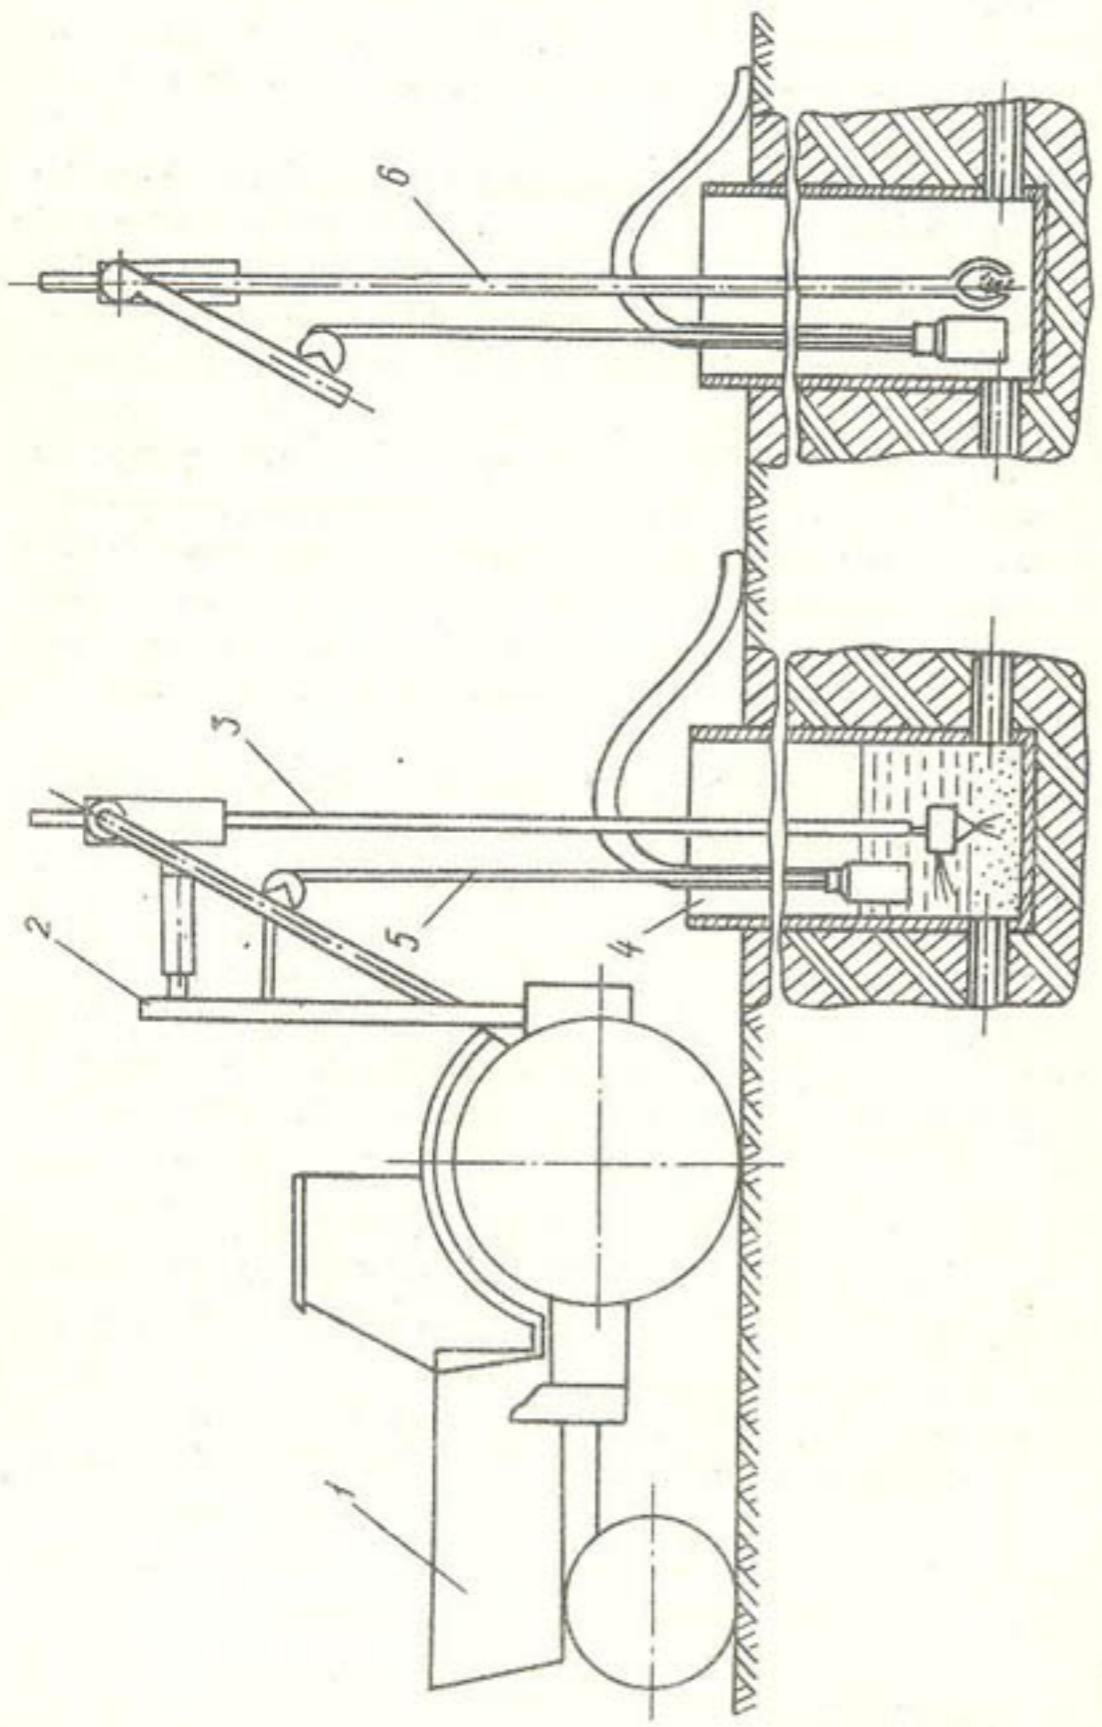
Оборудование для очистки колодцев КОРД-5: 1-трактор "Беларусь-821"; 2-устройство с захватом; 3-очистное оборудование; 4-напорный шланг; 5-шланг; 6-устройство с захватом
